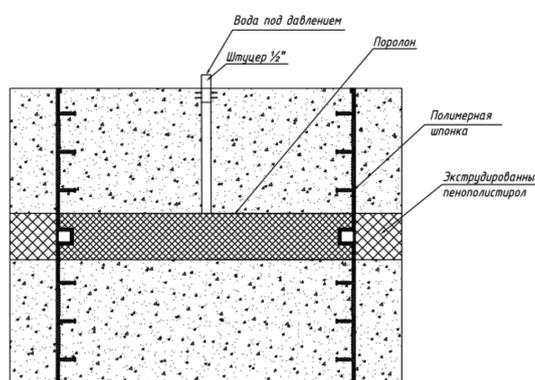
Схема стенда для испытаний гидрошпонки № 2
